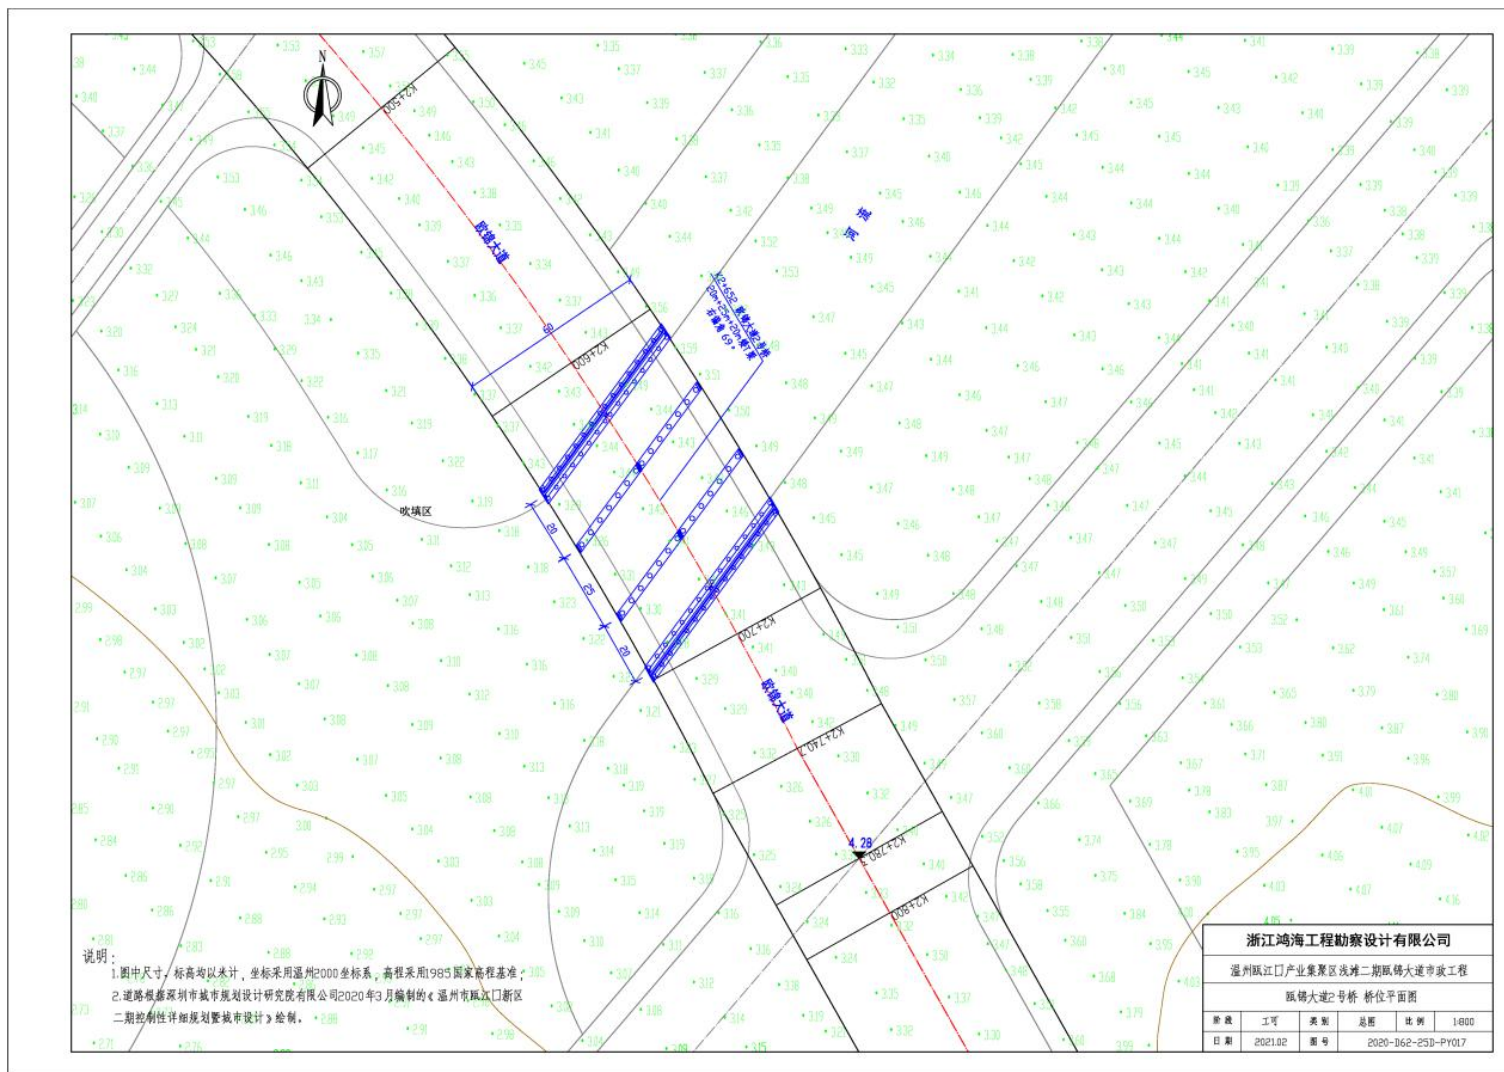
瓯锦大道 2 号桥桥位平面图
